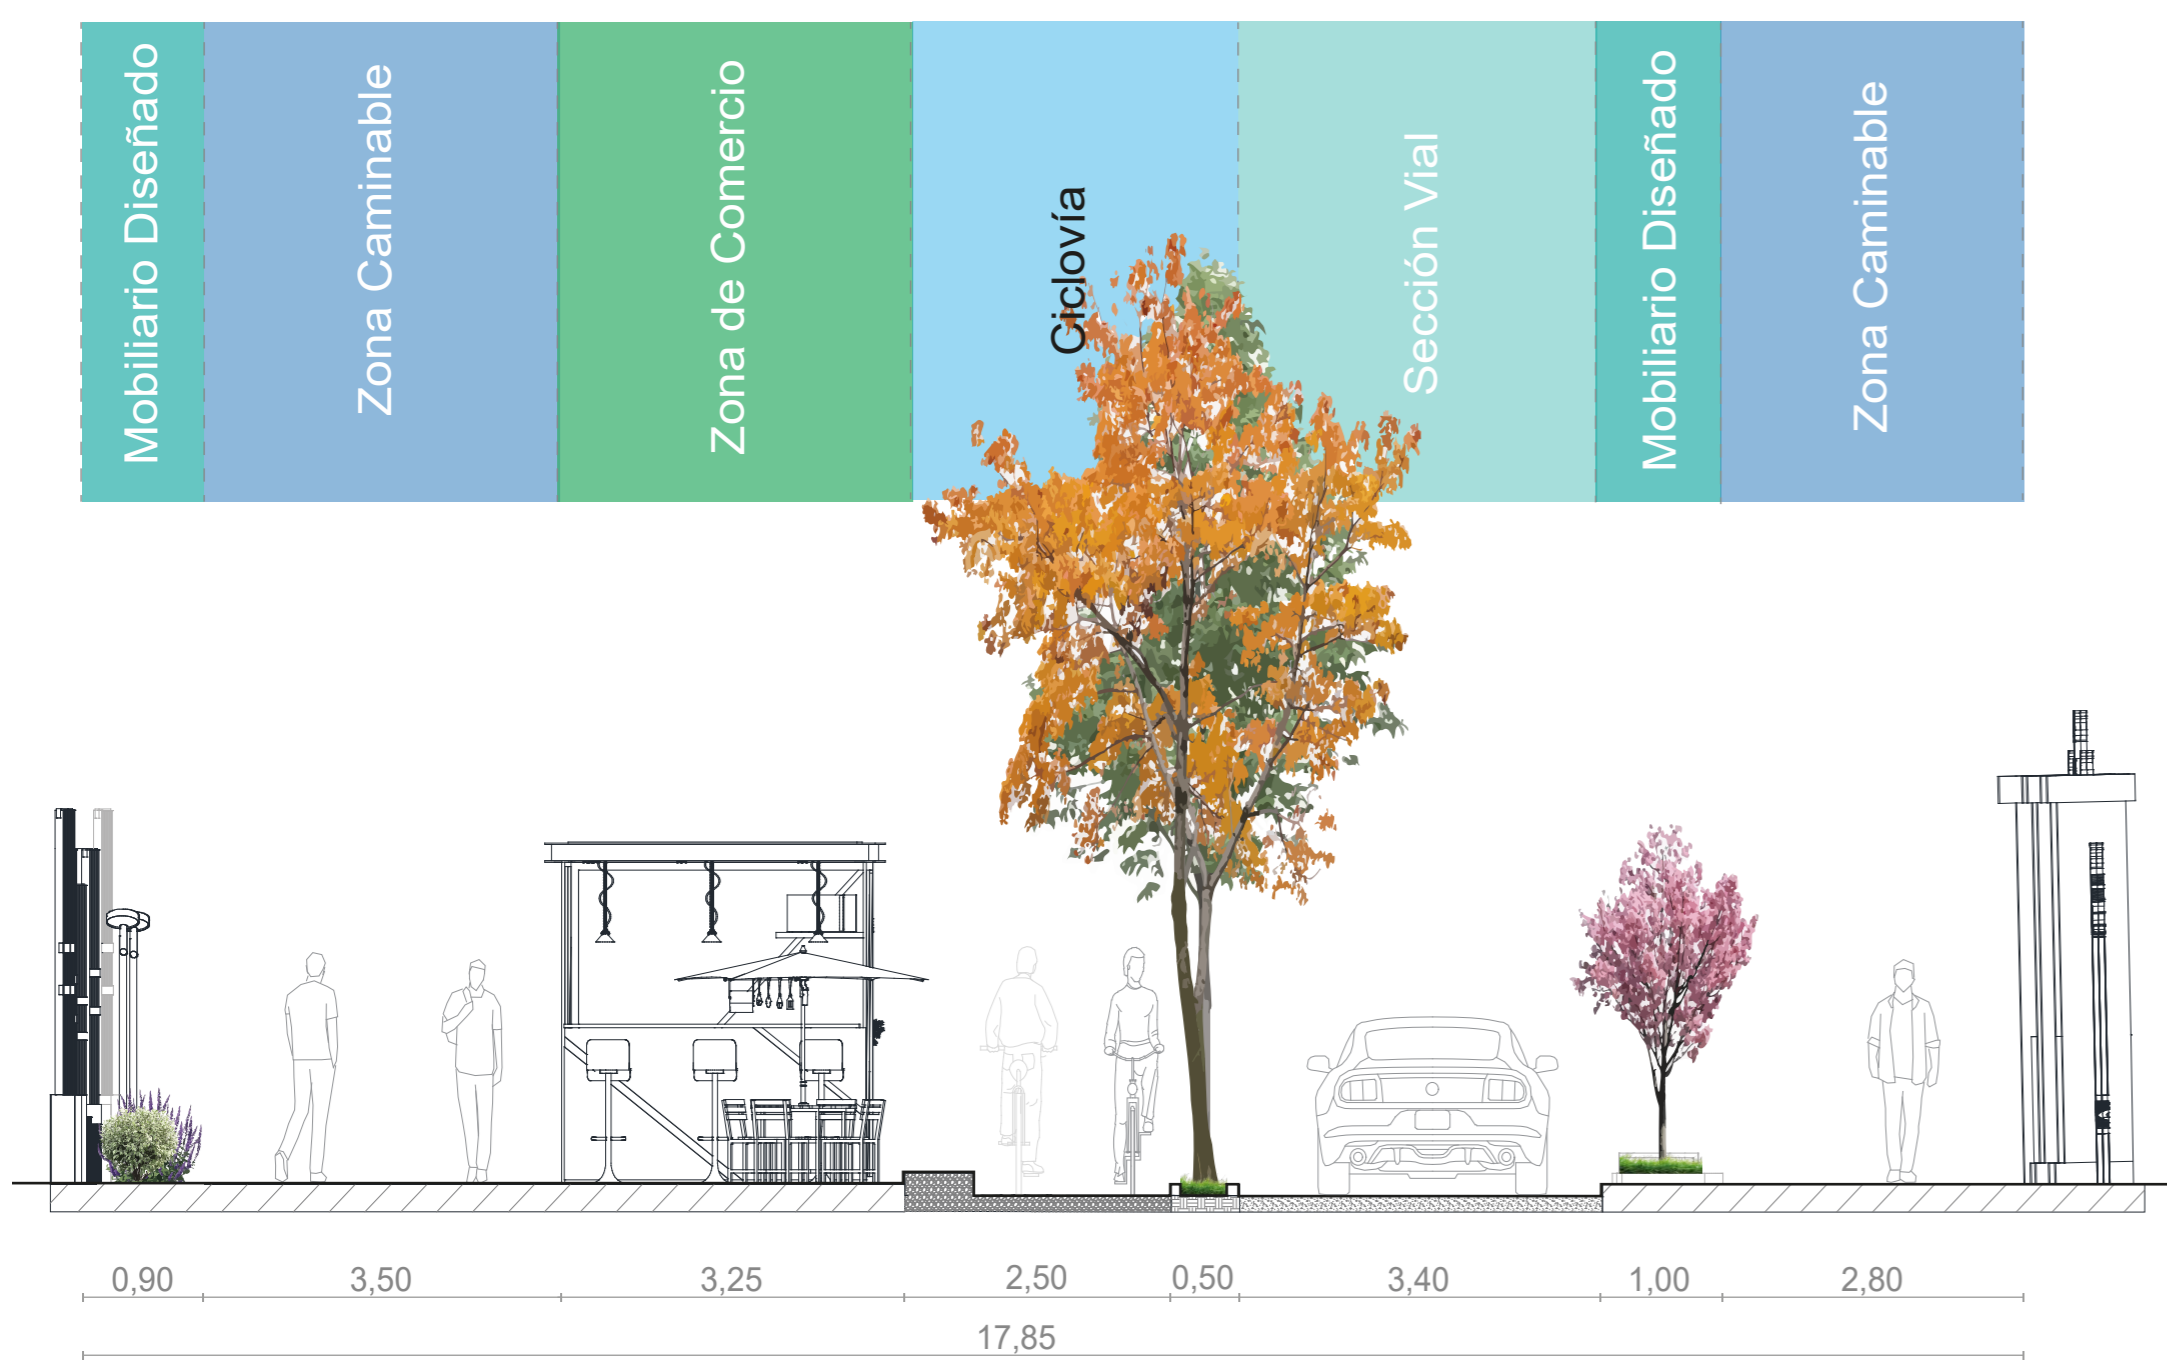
Planta-Sección de la propuesta en el Tramo 4
